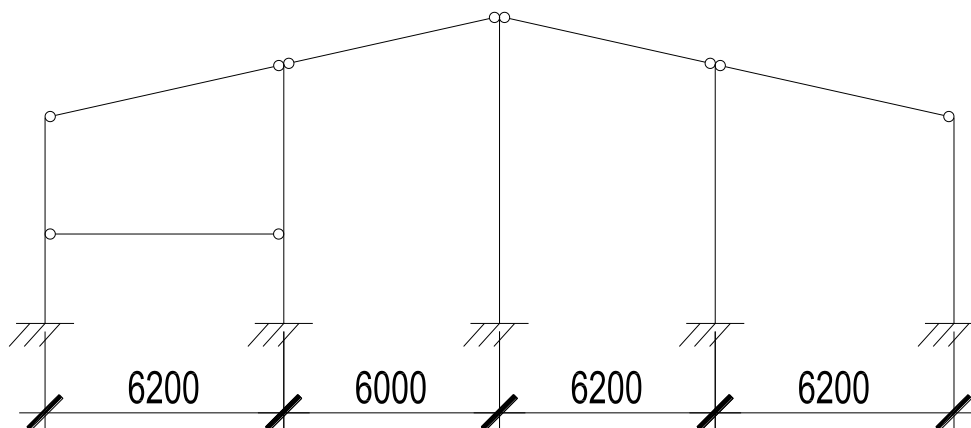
Расчетная схема поперечной рамы каркаса
